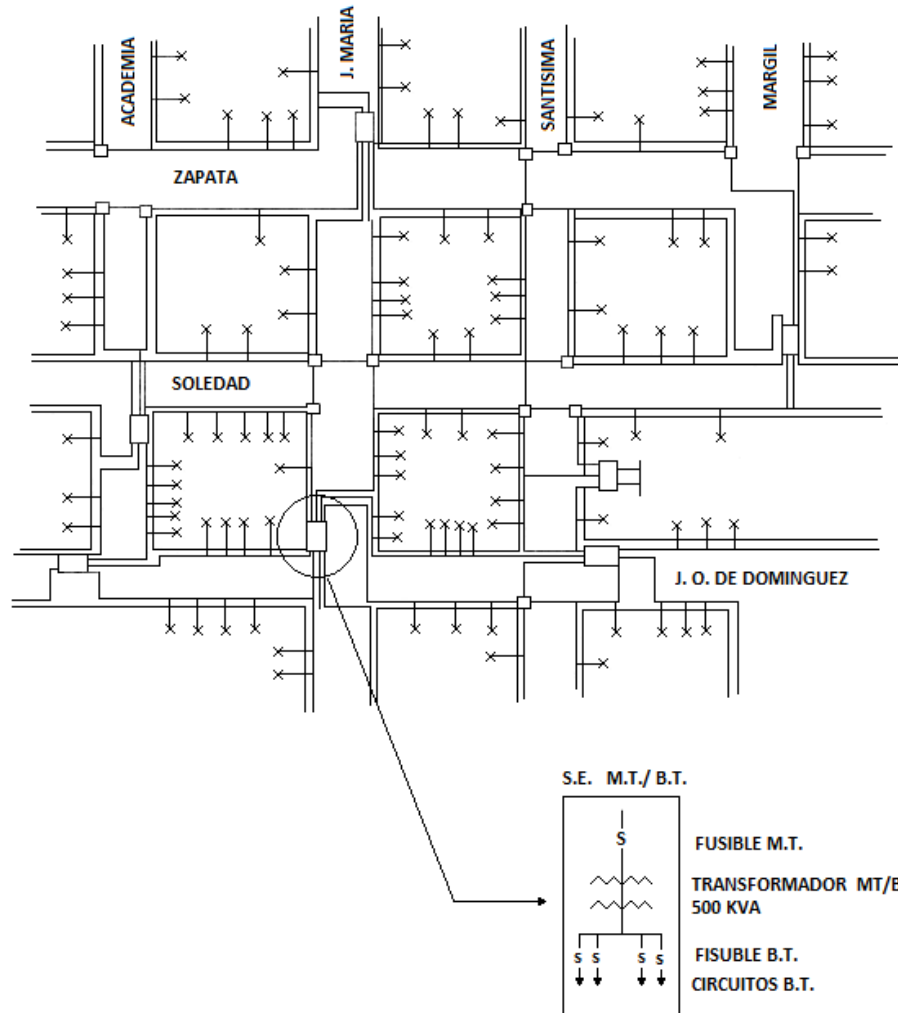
Estructura de Baja Tensión con Seccionamiento.
